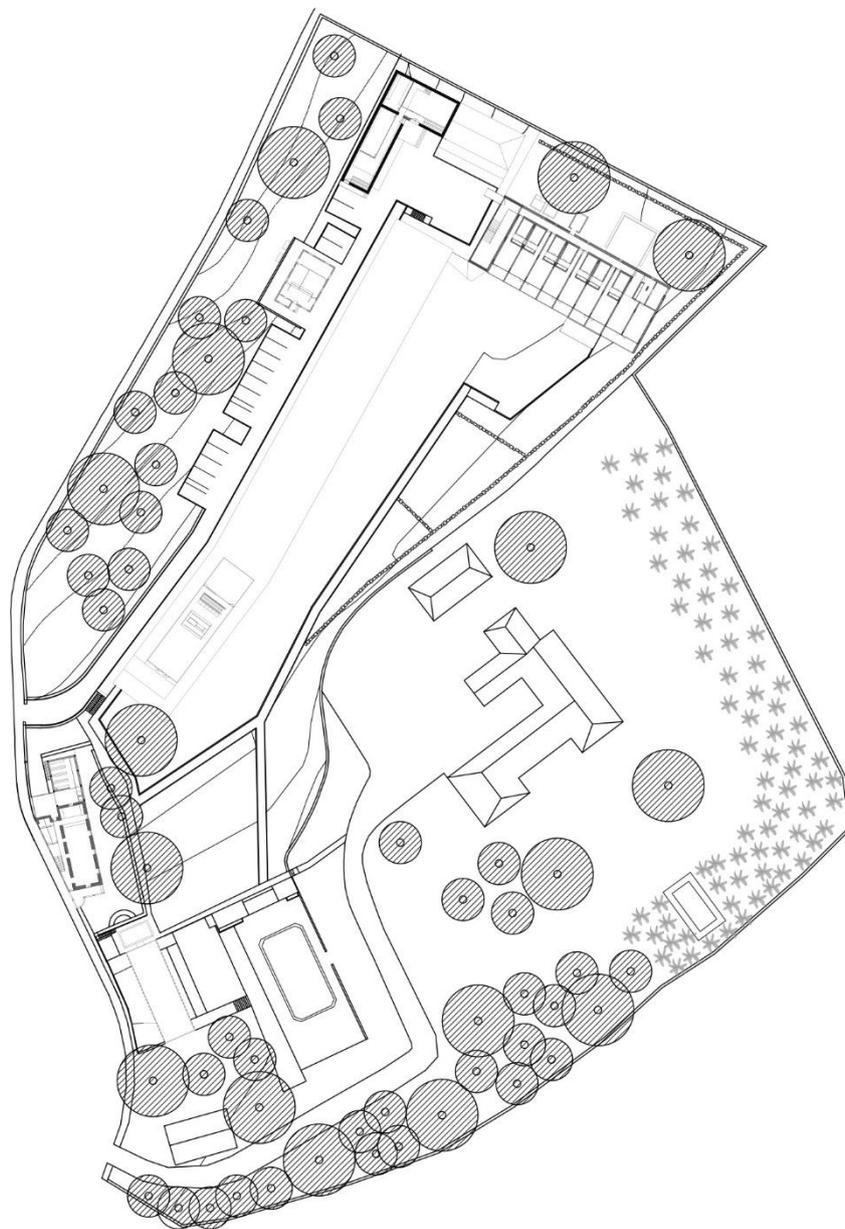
Planta de implantação à cota 78 da Quinta da Casa Branca, escala 1:2000
